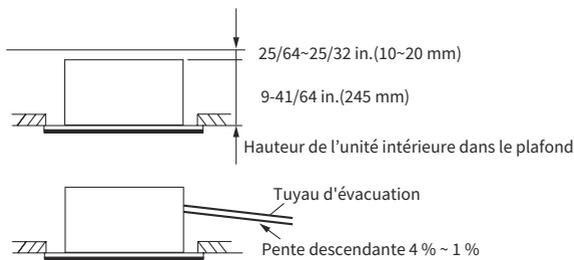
Emplacement d'installation de l'unité intérieure
